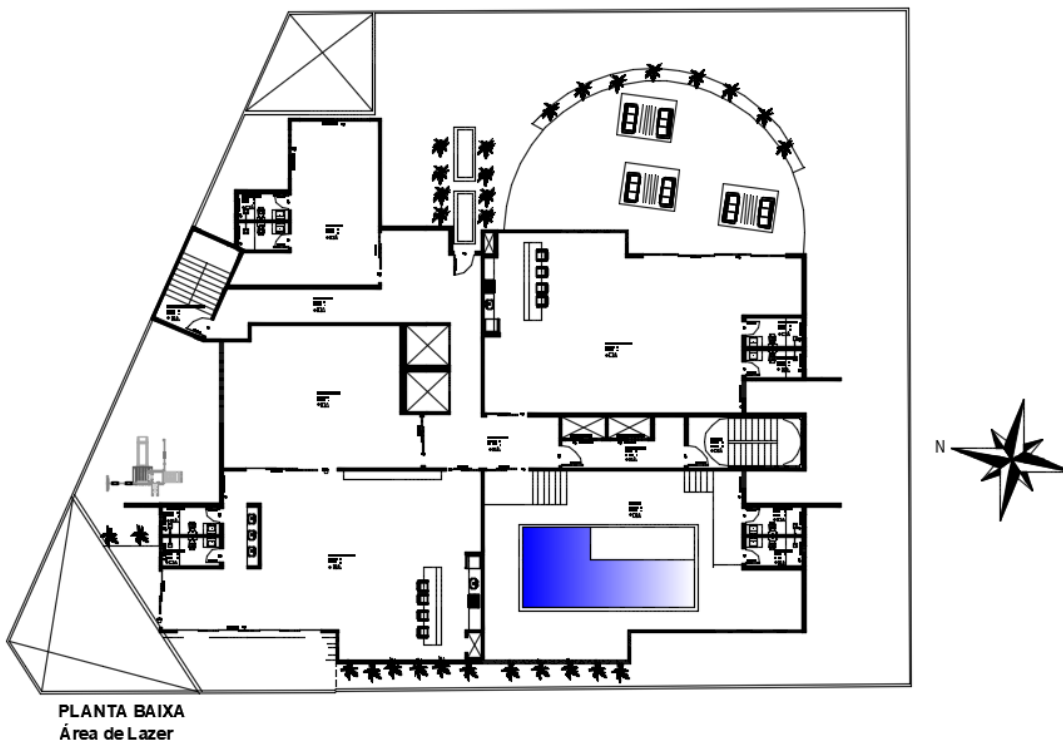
Projeto Arquitetônico – ÁREA DE LAZER
